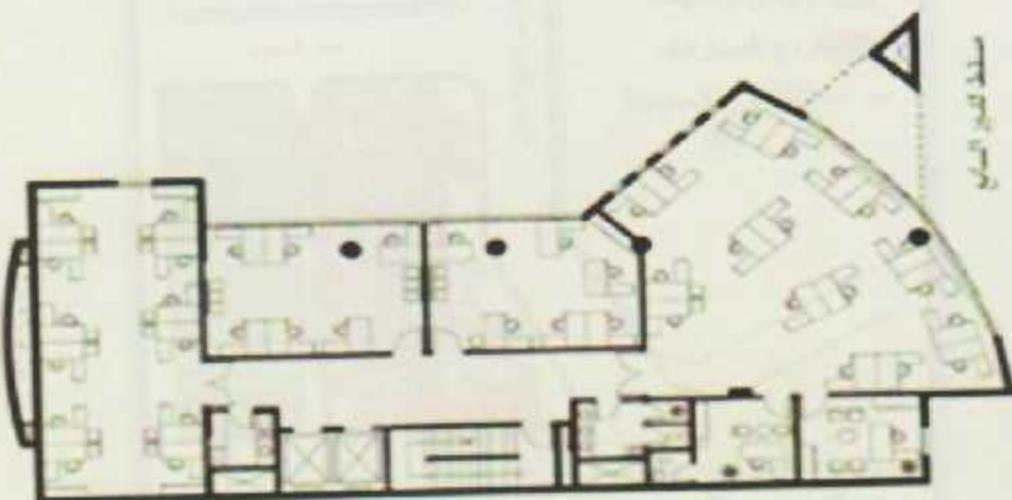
المسقط الأول والثاني لمبنى مكاتب عبد العزيز بن سعيد بن عبد الله السيد
